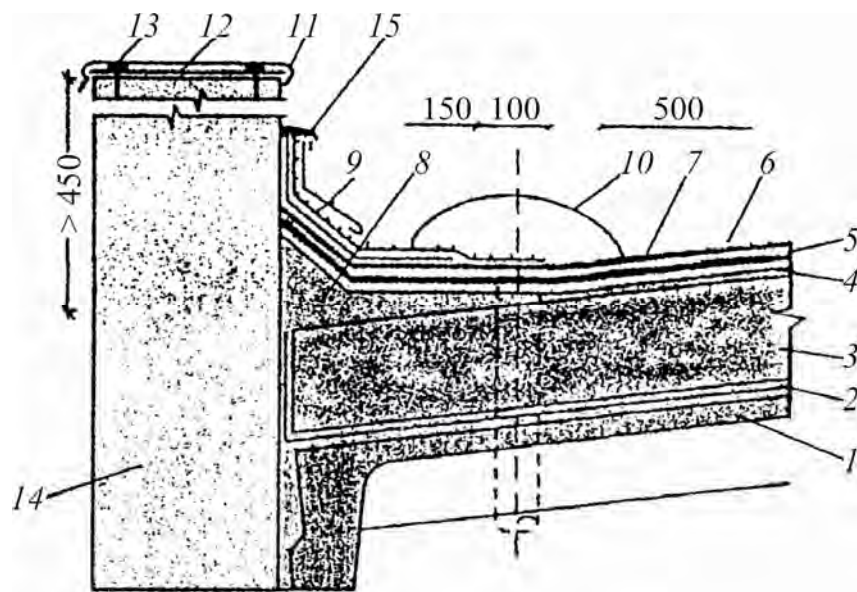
Примыкание кровли к парапету высотой более 450 мм: 1 — сборная железобетонная плита покрытия; 2 — пароизоляция (по расчету); 3 — теплоизоляция; 4 — выравнивающая стяжка; 5 — нижний слой основного кровельного ковра; 6 — верхний слой основного кровельного ковра; 7 — крупнозернистая посыпка; 8 — наклонный бортик; 9 — слои дополнительного кровельного ковра; 10 — воронка внутреннего водостока; 11 — оцинкованная кровельная сталь; 12 — костыли 40 × 4 через 600 мм; 13 — дубели; 14 — стена; 15 — герметизирующая мастика
